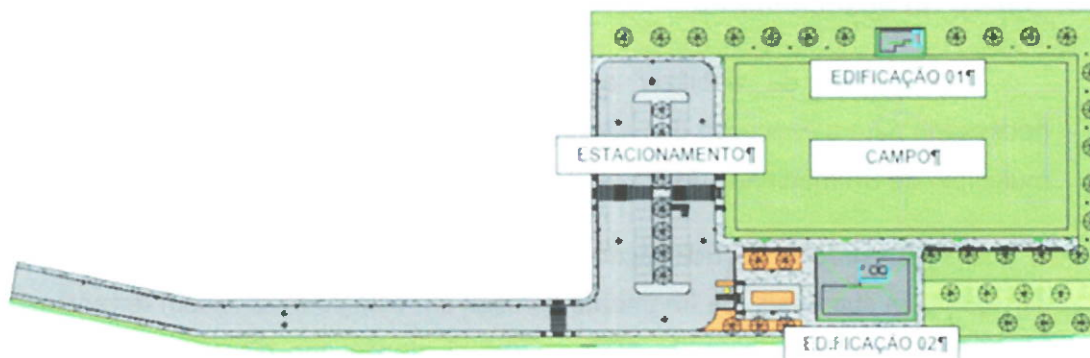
Planta de Implantação da OBR – Campo de Futebol
